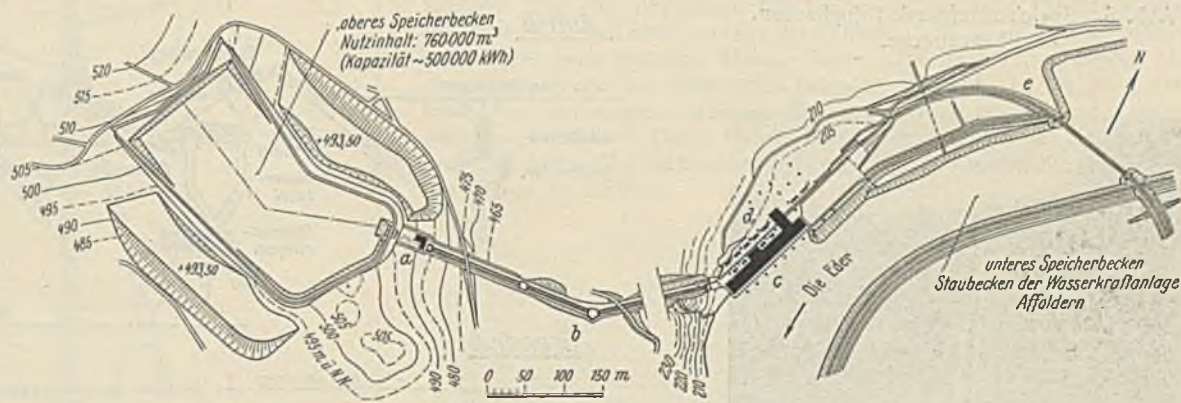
Übersichtslageplan des Speicherkraftwerkes Bringhausen.
